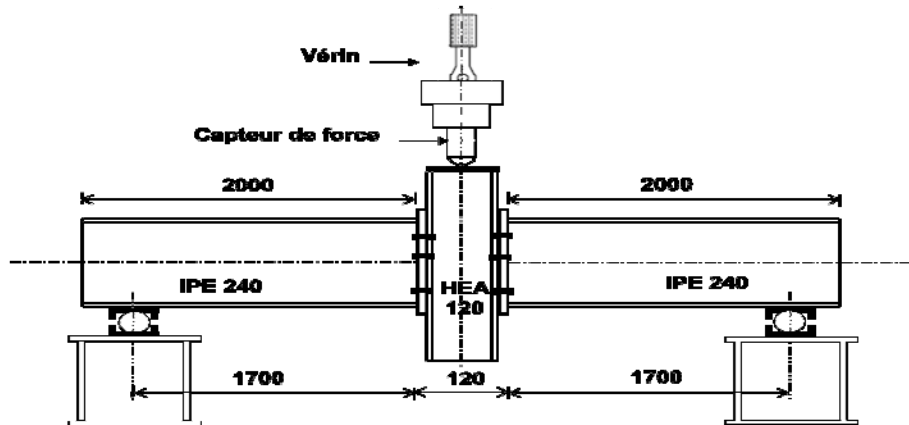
Montage expérimental de l'assemblage FS1
